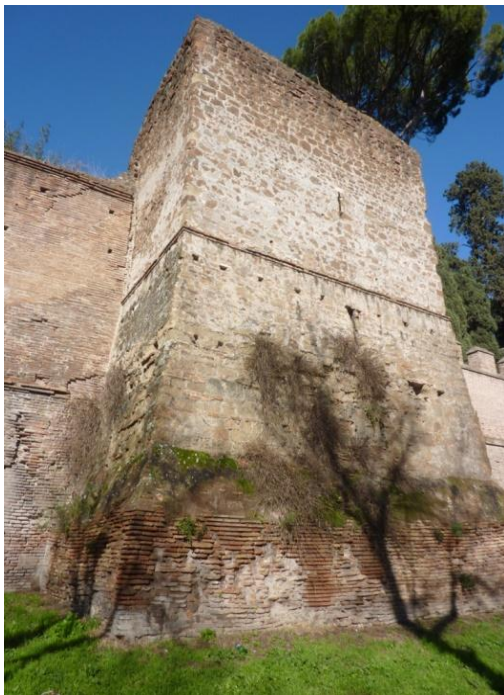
Torre M7 vista da sud. Foto D’Ippolito.
